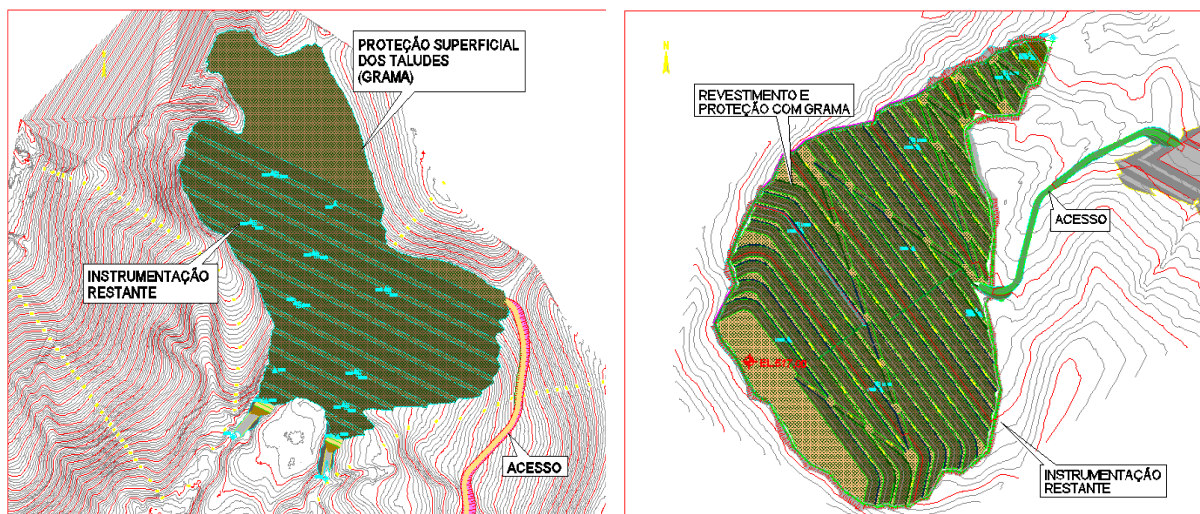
Drenagem superficial, proteção dos taludes e instrumentação (Pilha 1)
